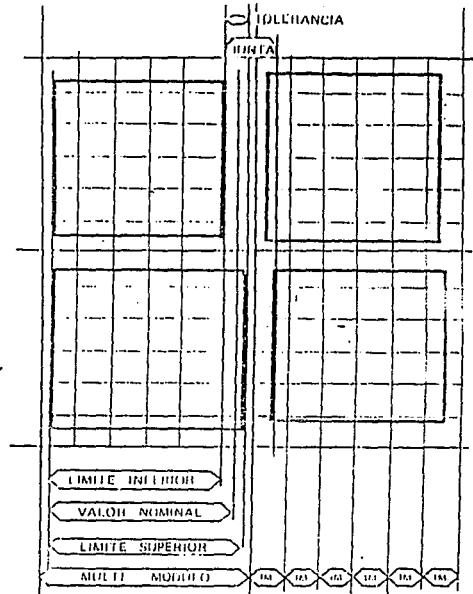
Tolerancias Dimensionales en Juntas.
